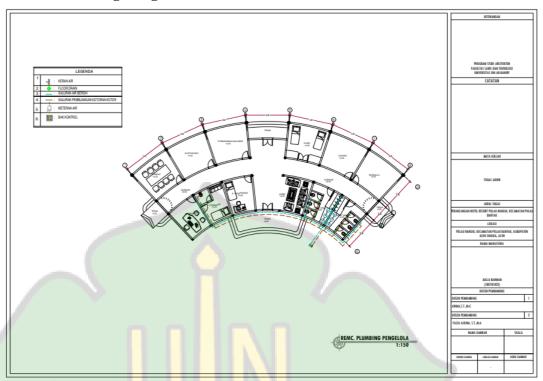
Denah Elektrikal Mess Karyawan 6.1.42 Denah Plumbing Pengelola
